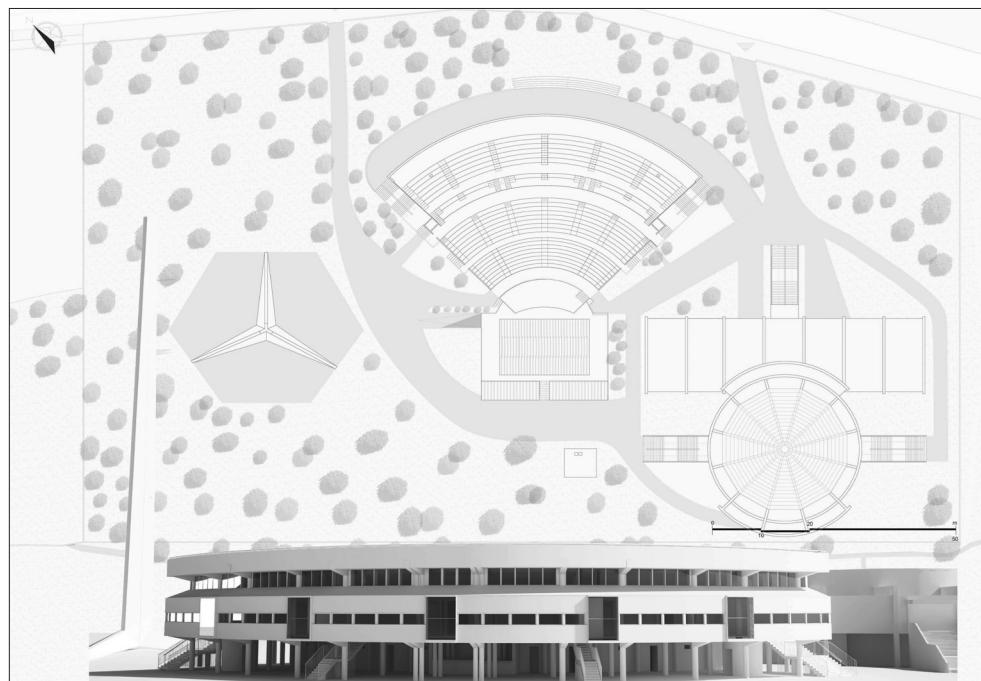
LEVANTAMIENTO DE LA PLANTA BAJA Y DE LA FACHADA PRINCIPAL. *Imagen: I. Adrakta, 2014.
